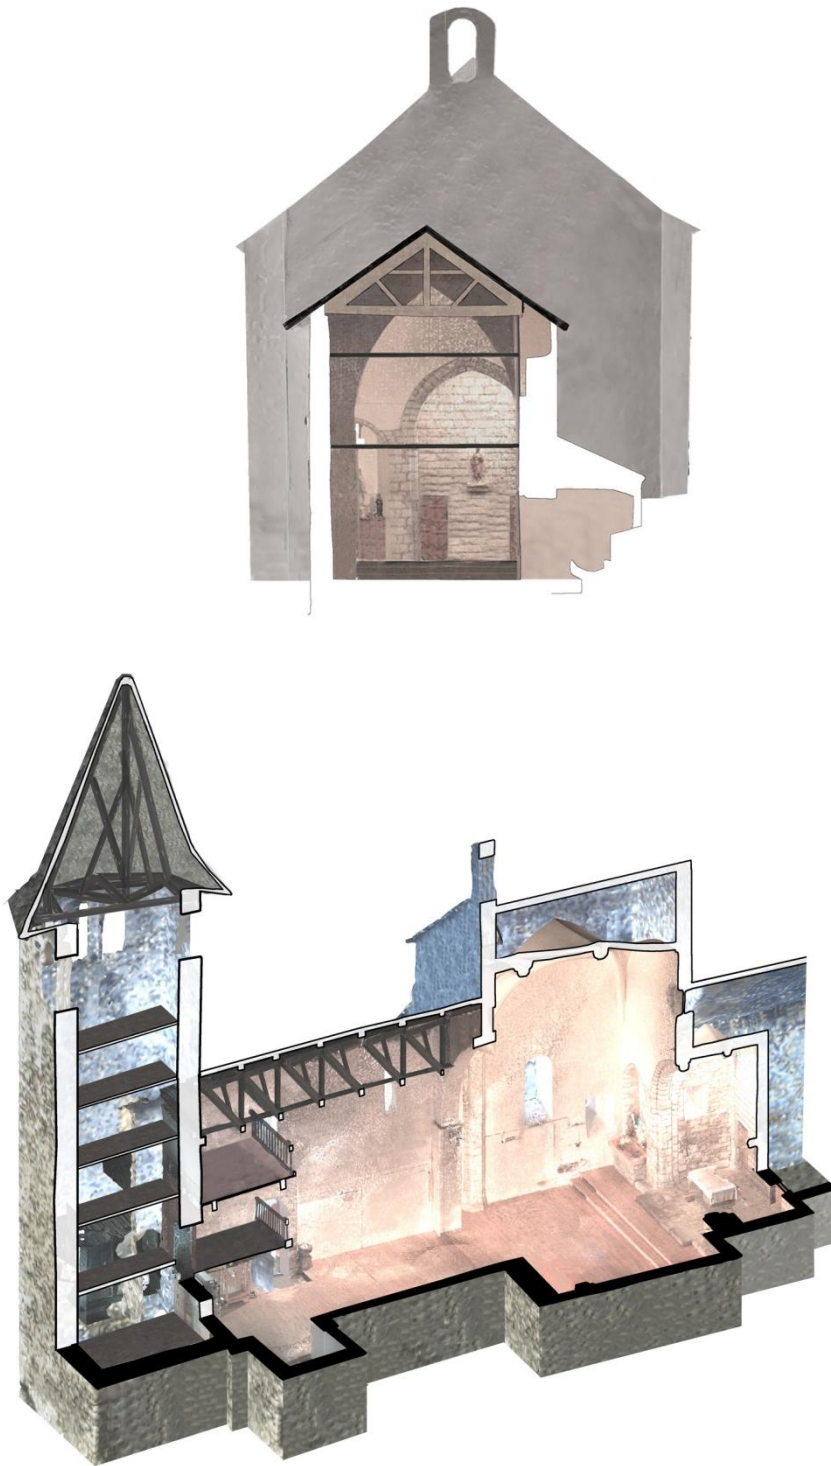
Planimetría de la Iglesia de Sant Pèir d'Escunhau. e.:1/200.
